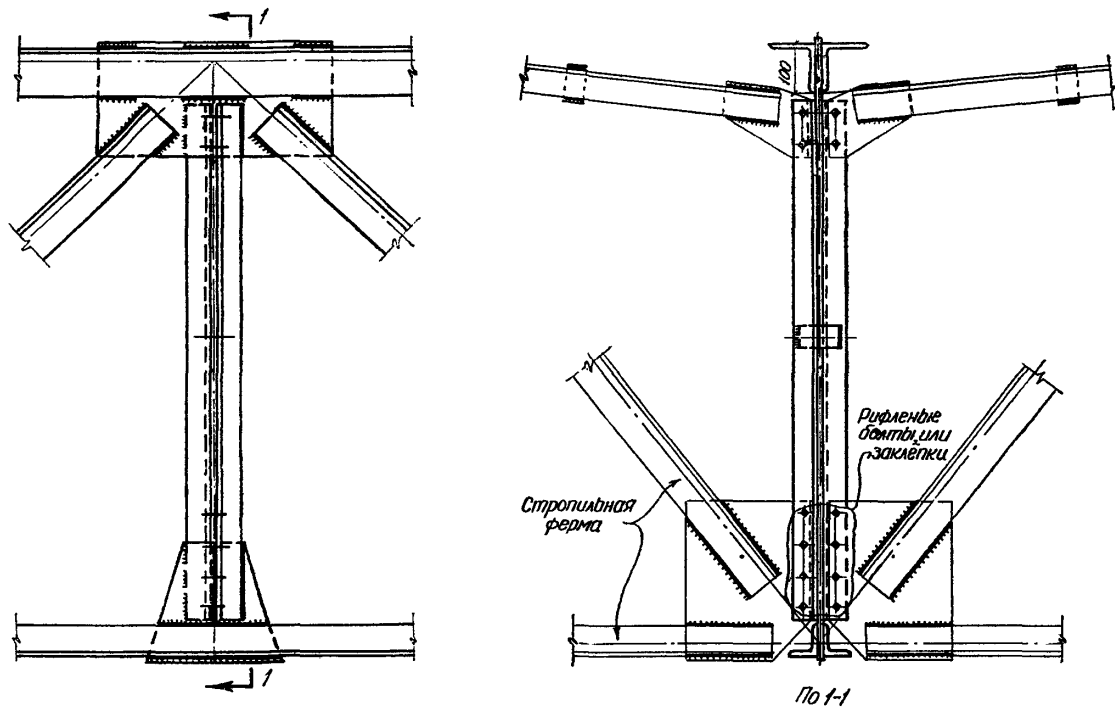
Крепление полигональной стропильной фермы к подстропильной на рифленых болтах или заклепках
